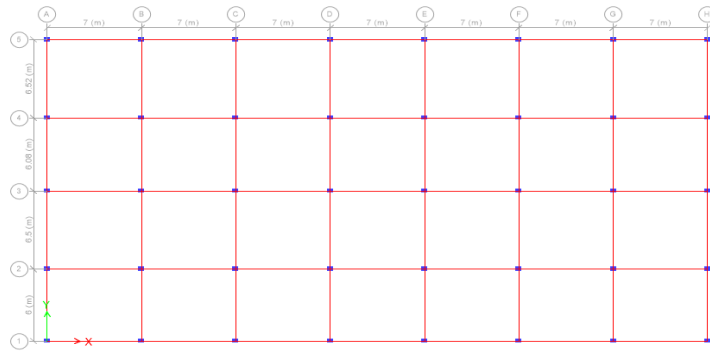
Vista en planta de columnas y vigas graficadas en el software ETABS.
